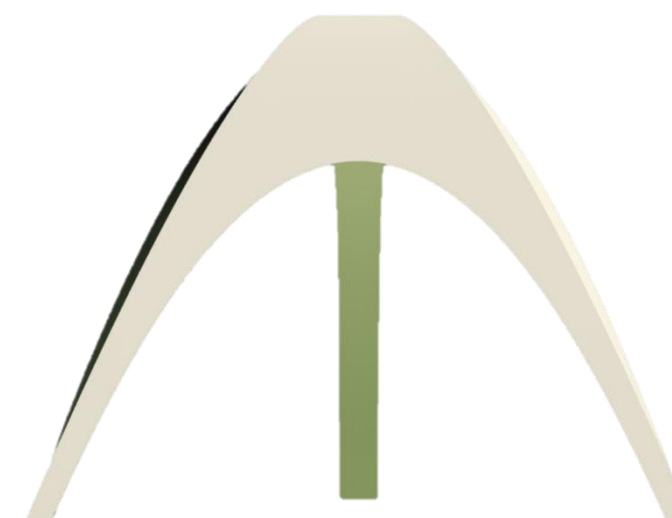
PERFIL DERECHO, PARÁBOLA LATERAL.
